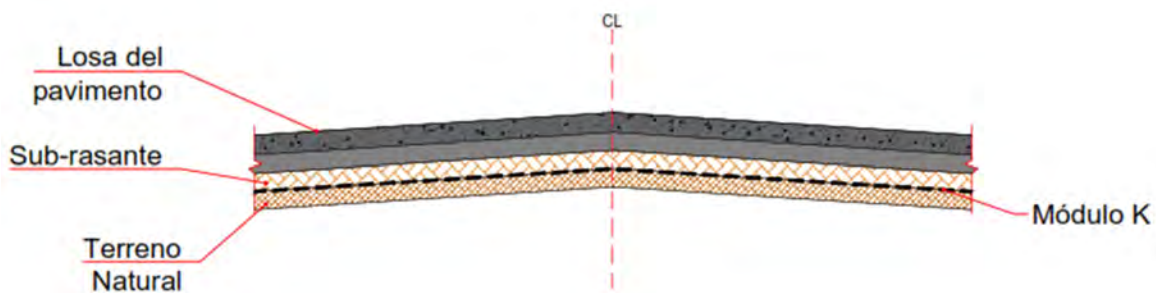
Sección de pavimento rígido en la cual se identifica el “módulo K”.
